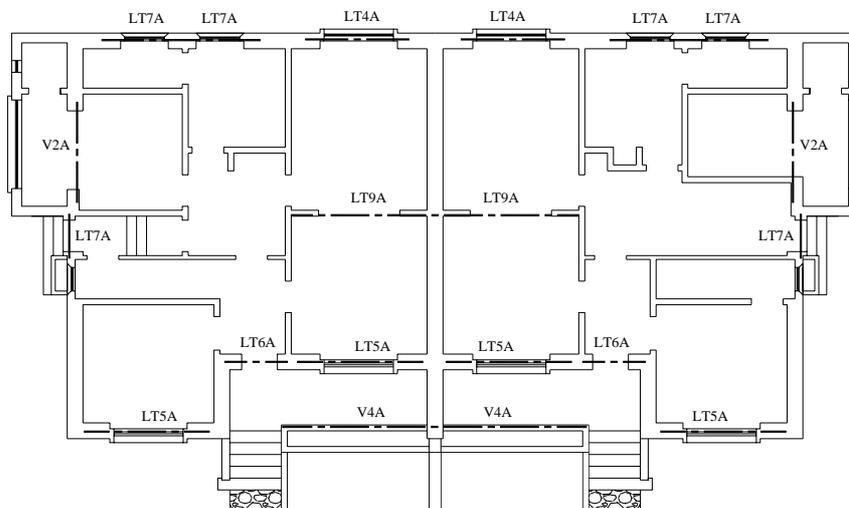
Planta do piso térreo de uma moradia geminada, com 2 pisos elevados, e com lintéis assentes na zona superior dos vãos de porta e de janela.
